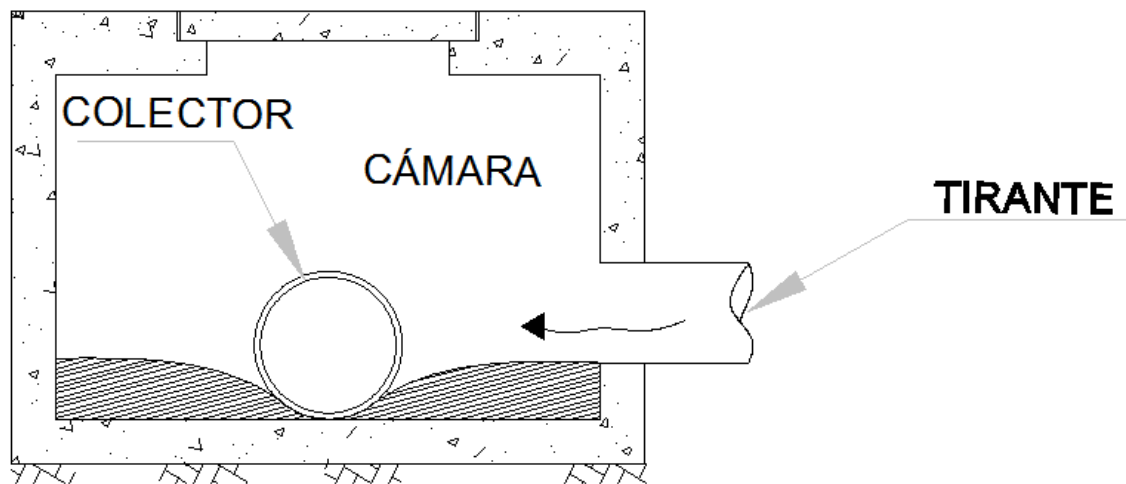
Componentes de un sistema de alcantarillado pluvial (2)
